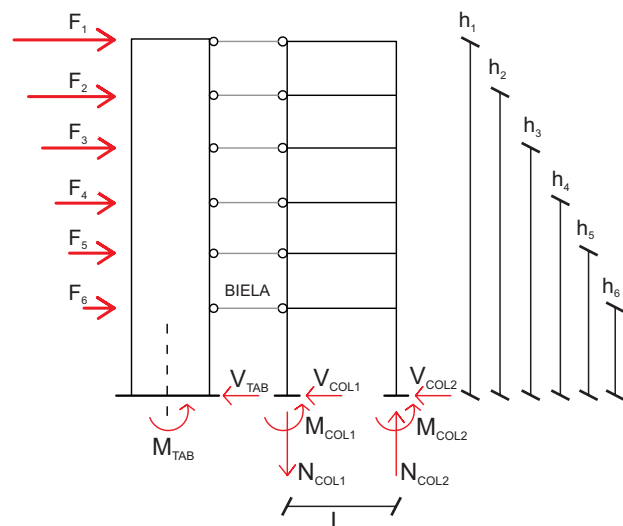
Caso C - Tabique y pórtico con viga de conexión
